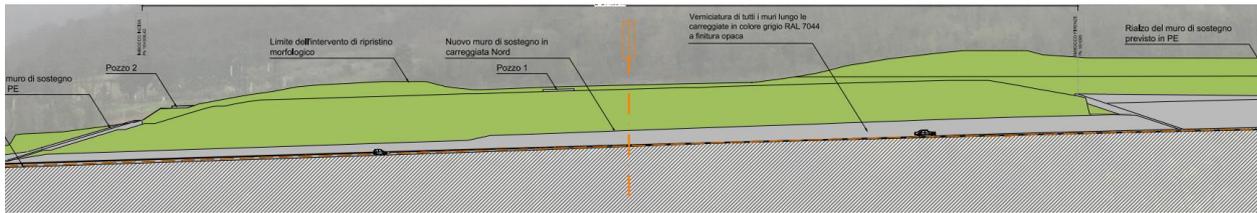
Prospetto nuova carreggiata sud: muro di sostegno molto ridotto in altezza
